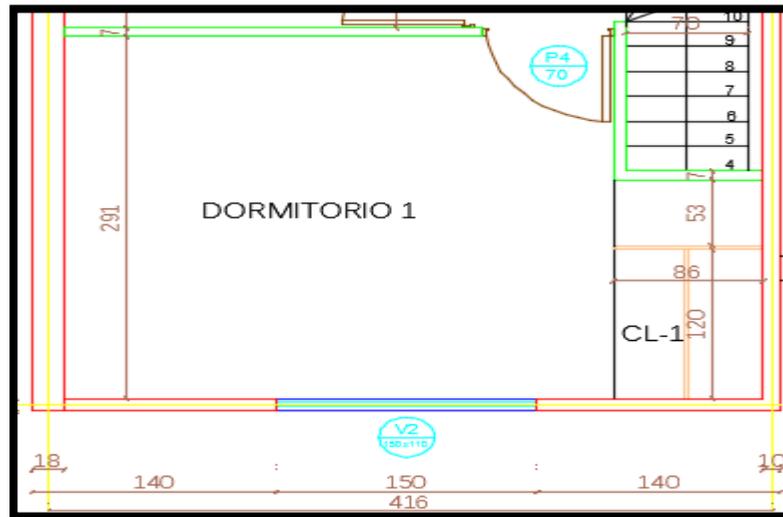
Planta del dormitorio1. (Dimensiones en cm)
